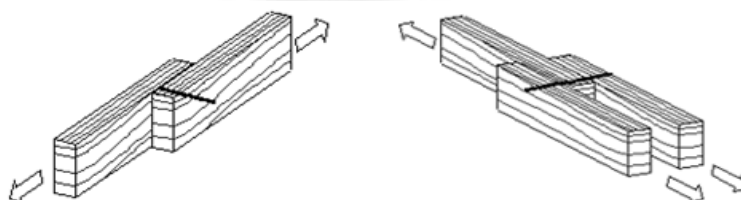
Uniones clavadas sometidas a simple y doble cizallamiento
